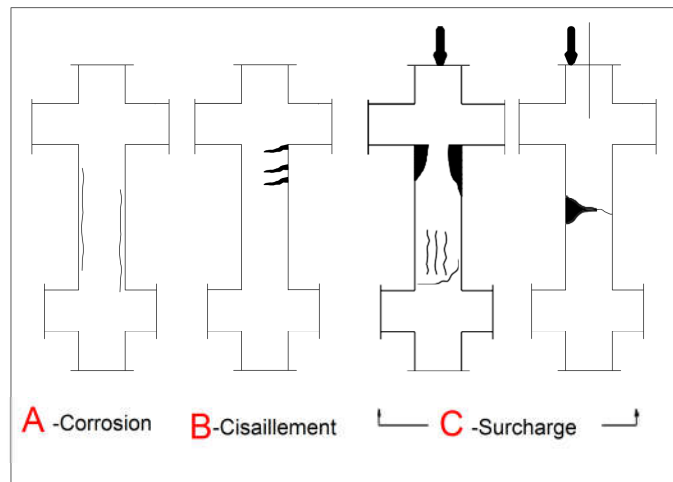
Fissures probables affectant les poteaux.
